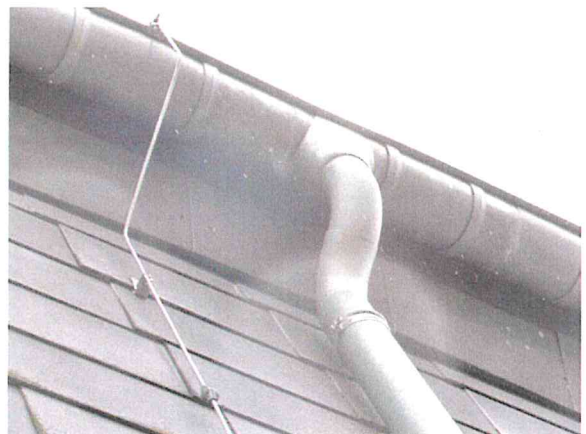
Übergang von Fassade zum Dach (ohne Spaltenverstecken (Fledermäuse))
